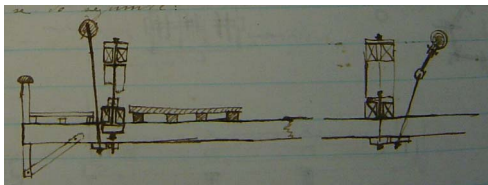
Detalhes da Ponte em Nashville. (FONTE: SOUZA, 1869b).
